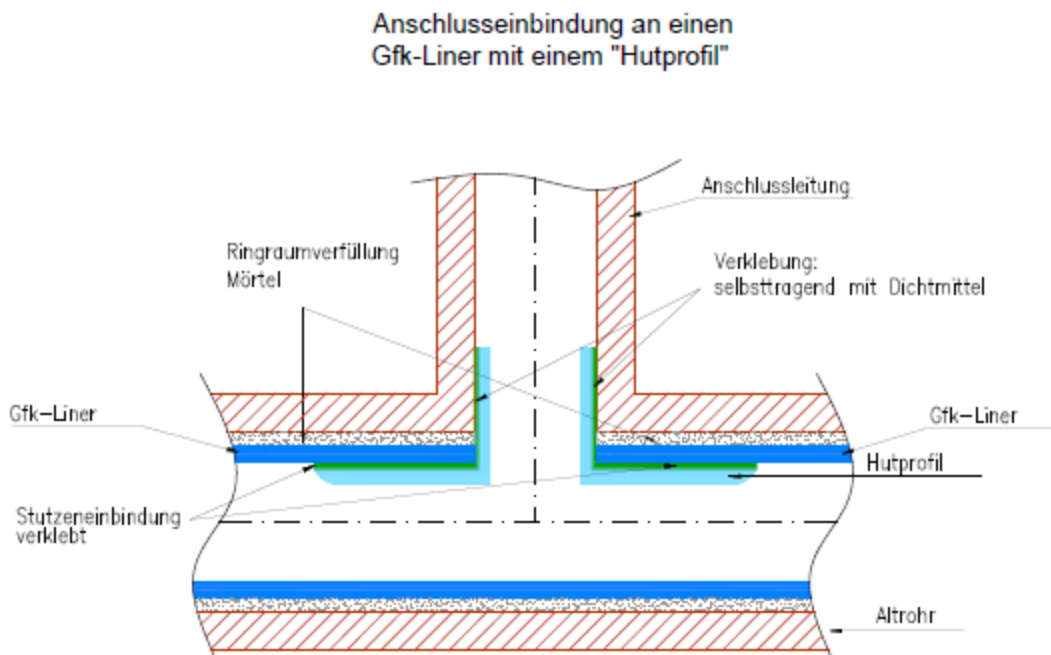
Beispiel für die Anschlusseinbindung an einen GFK-Liner, Hutprofiltechnik
